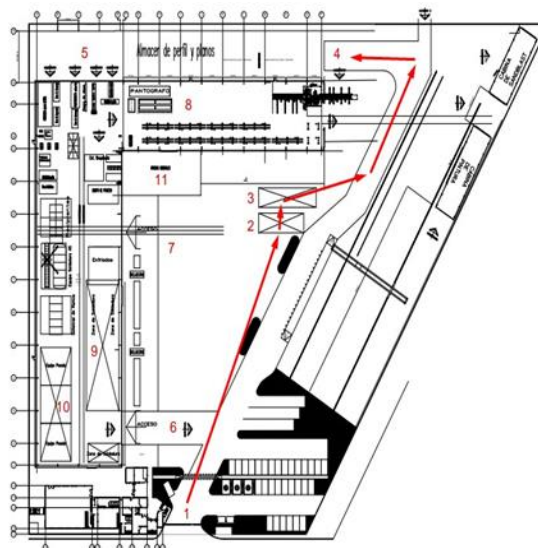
Layout prueba 2 de la Planta Durosa Santa Rosa SA, de CV.
